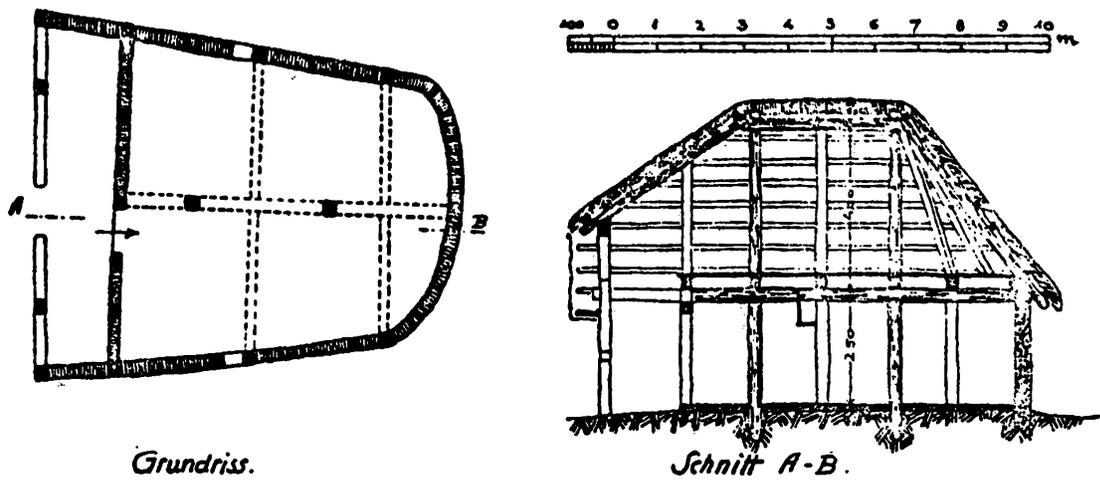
Grundriß des Hauses von Oerlinghausen.
